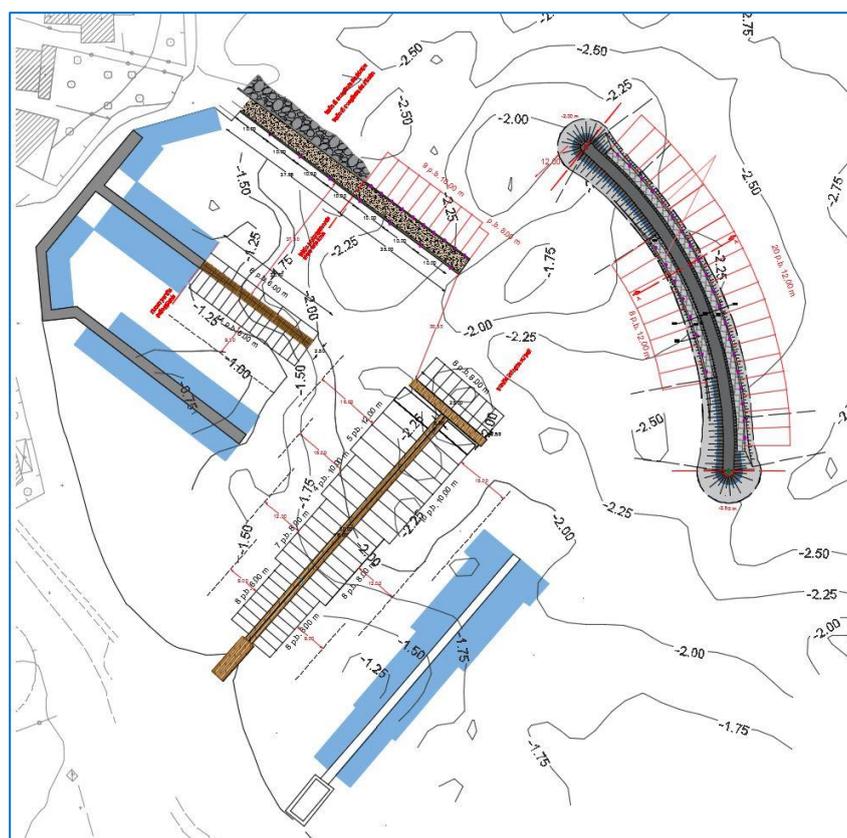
Planimetria dell'area portuale con indicazione degli ampliamenti in progetto
